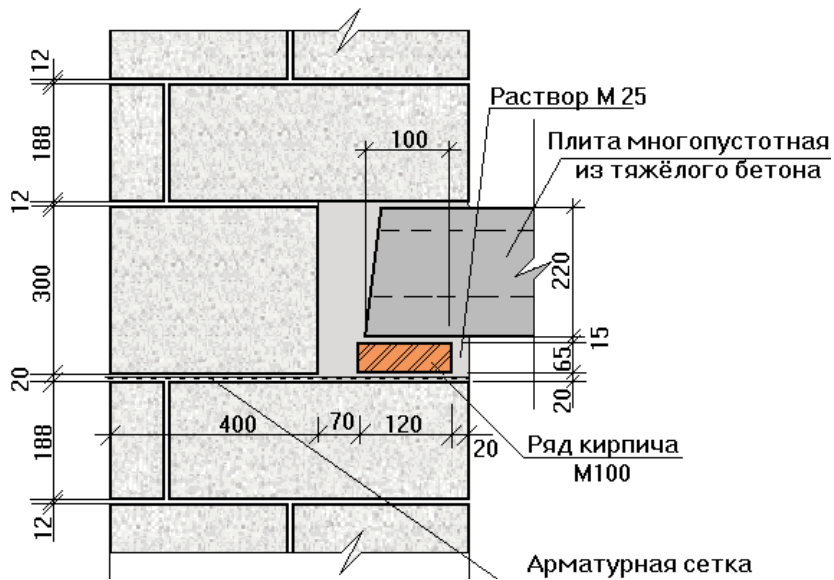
Пример опирания железобетонной плиты перекрытия на стену толщиной 610мм.
